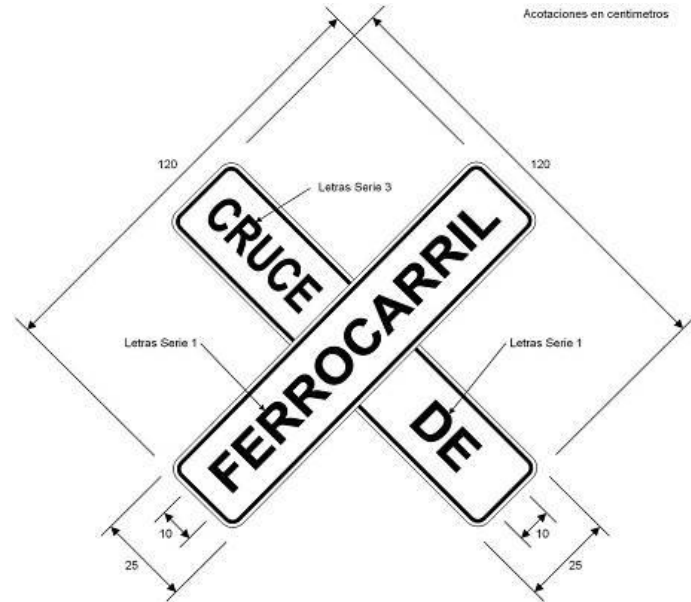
Señal informativa de recomendación sir de cruce de ferrocarril
